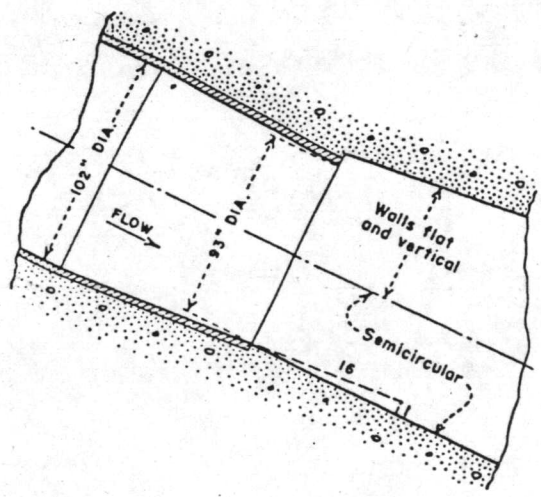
Damage Caused by Protruding Joint in Hoover Dam Spillway Tunnel
